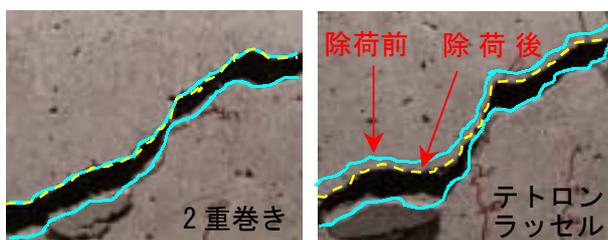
除荷後にひび割れ幅が閉じた状況
